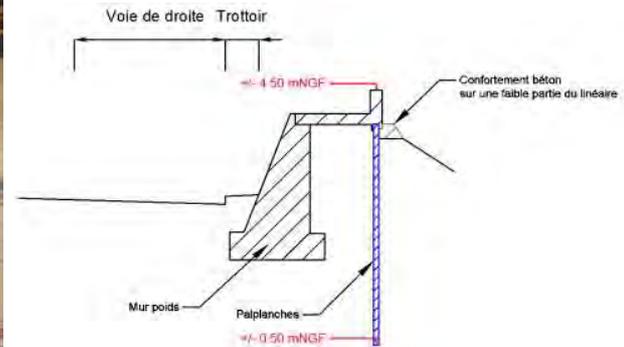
Digue de type rideau palplanches - ouvrage de Saint-Jean-Belcier : Source : EPA - Etude de danger de la digue Saint-Jean Belcier - 2013
